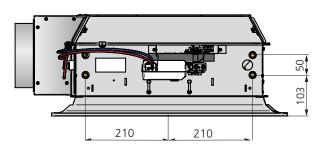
Abmessungen, Wasseranschluss Länge 600, 1200, 1800
